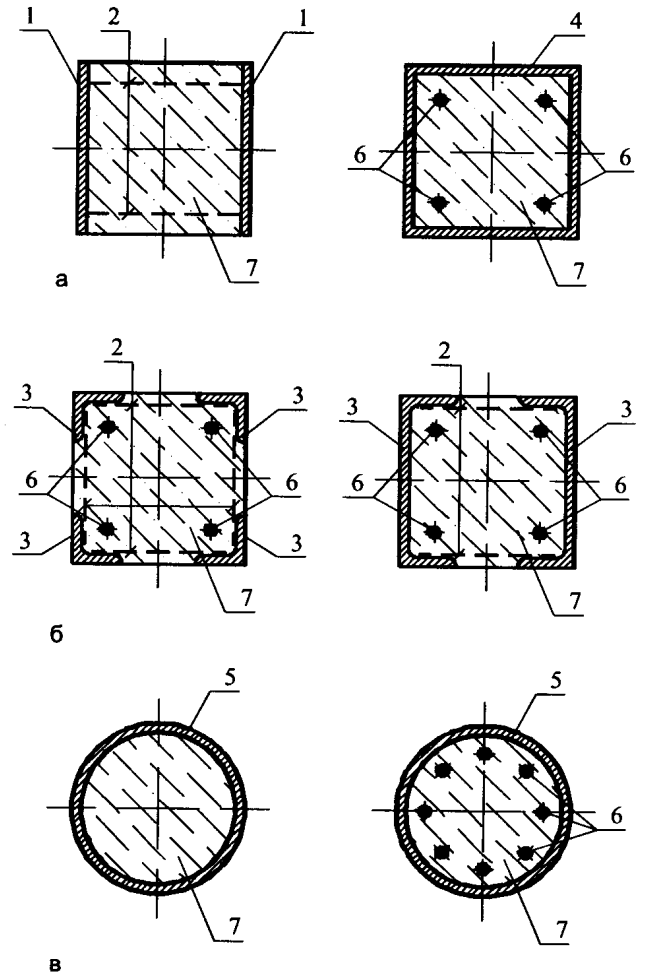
Поперечные сечения сталежелезобетонных колонн с внешним расположением жесткой арматуры в сечении
